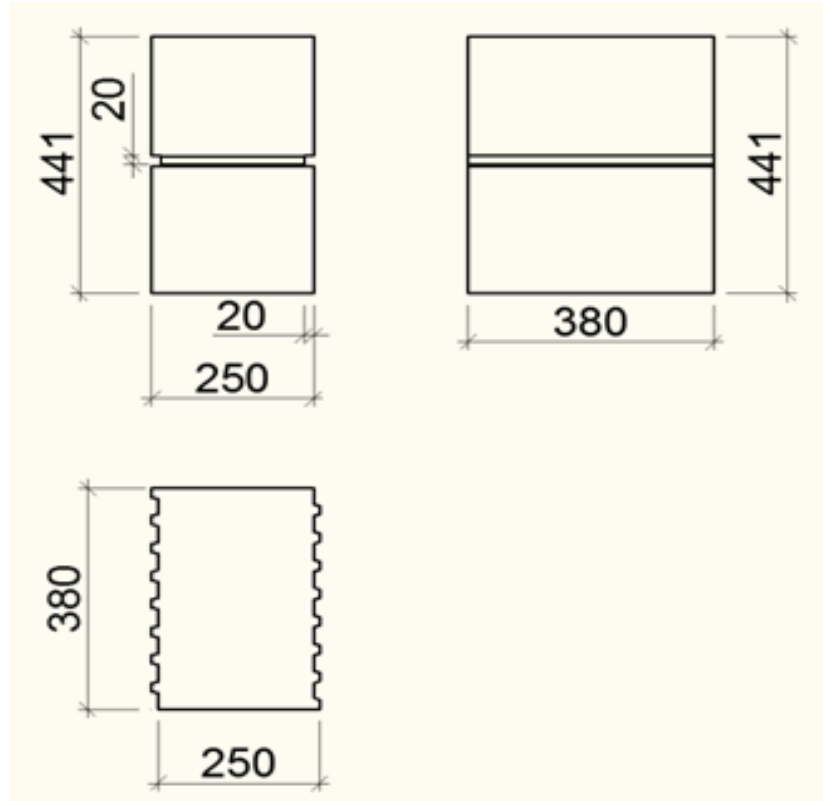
Размеры опытных образцов для испытаний на осевое растяжение
